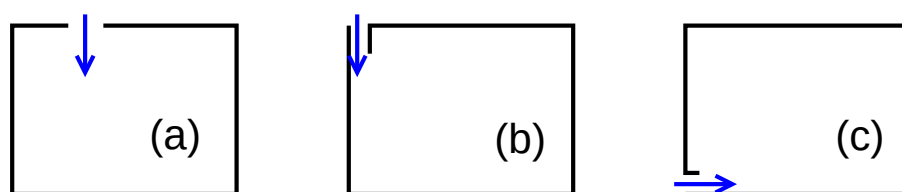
positionnement des bouches de soufflage ; (a) en plafond ; (b) en jet pariétal ; (c) au niveau du sol.
